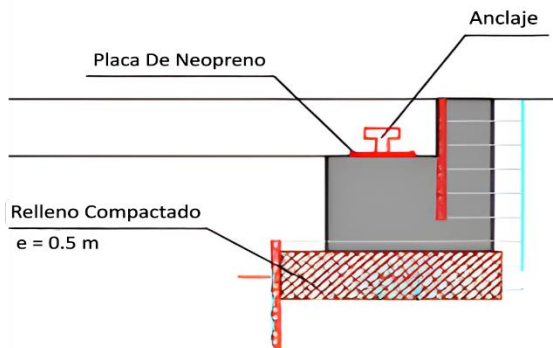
Sistema de anclaje de los contenedores, sistema de piñas de anclaje similar a las utilizadas para el transporte de contenedores, empotrado en el estribo de hormigón prefabricado.
